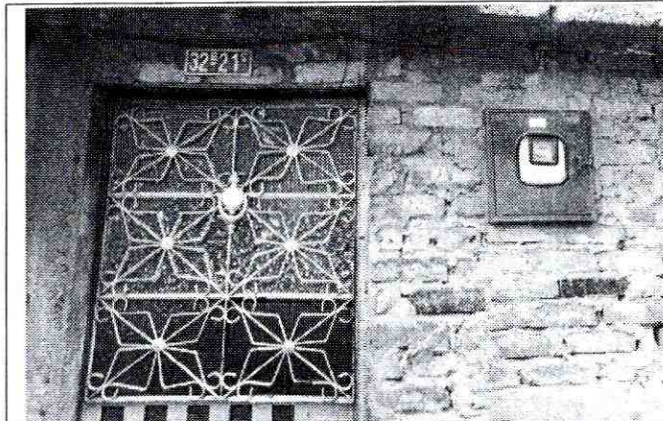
Vista general de fachada del predio ubicado en la Tv 15A # 32B-21 Sur.
